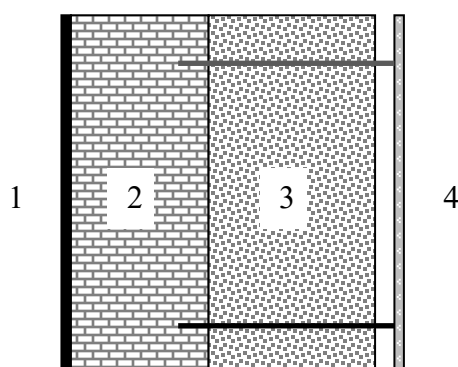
Вариант ограждения: 1 – на внутренней поверхности известковая штукатурка толщиной 15мм, 2 – кладка глиняного кирпича толщиной 250мм на цементно-песчаном растворе, 3 – плита минераловатная из каменного волокна, 4 – навесной вентилируемый фасад на кронштейнах
